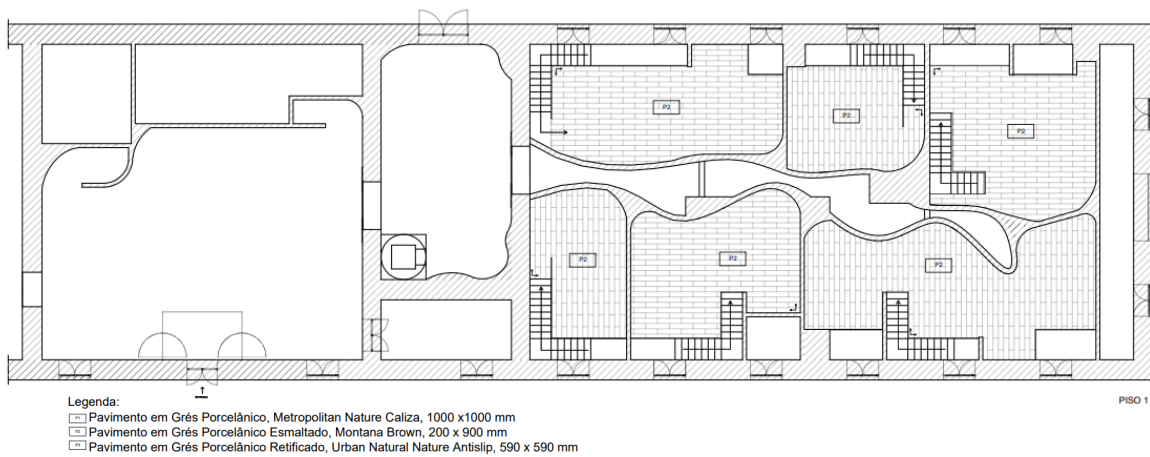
II - Planta de Pavimento, Piso 1, Alojamento Olive
